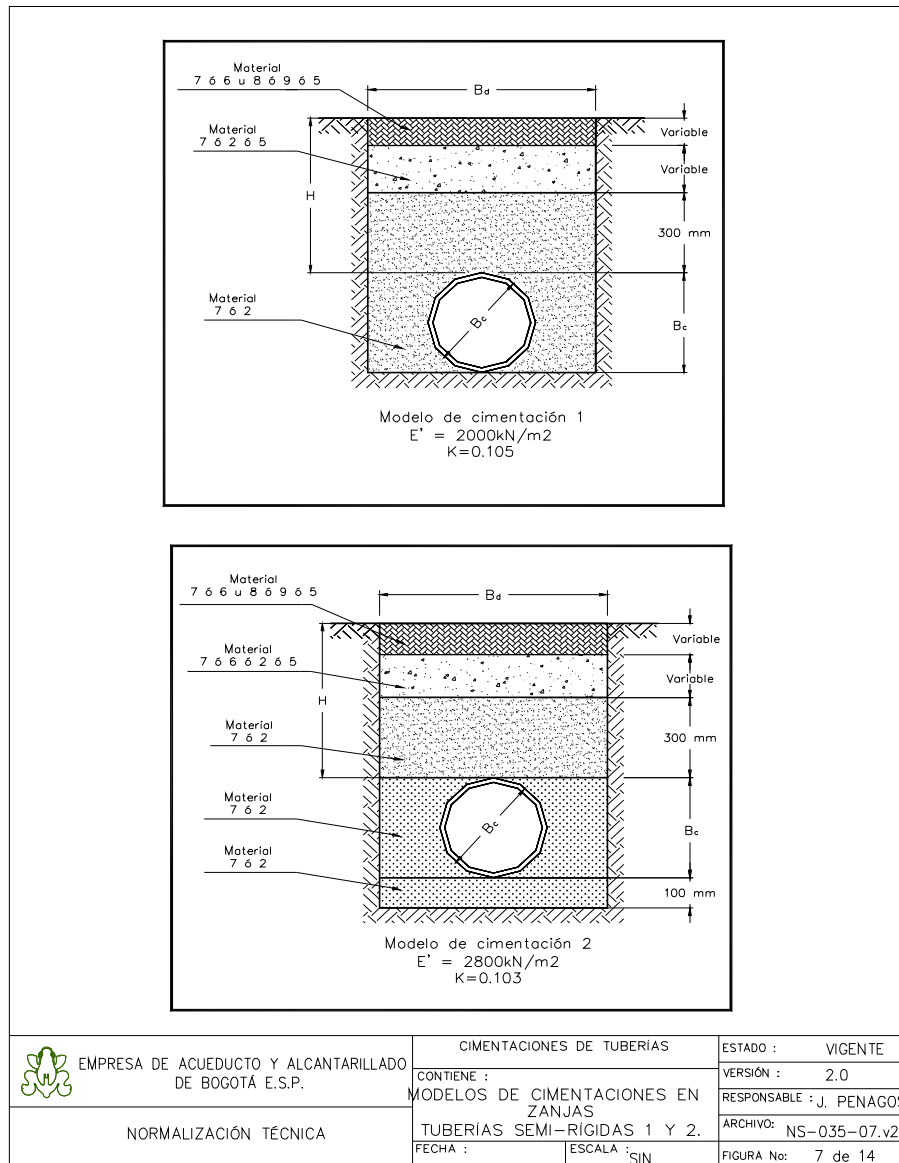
Cimentación de tuberías recomendadas por la EAAB para instalación de tuberías en la que se considera la construcción de estructura de pavimento y relleno con material proveniente de la excavación por encima del lomo de la tubería tomado del Anexo C de la Norma NS-035.
